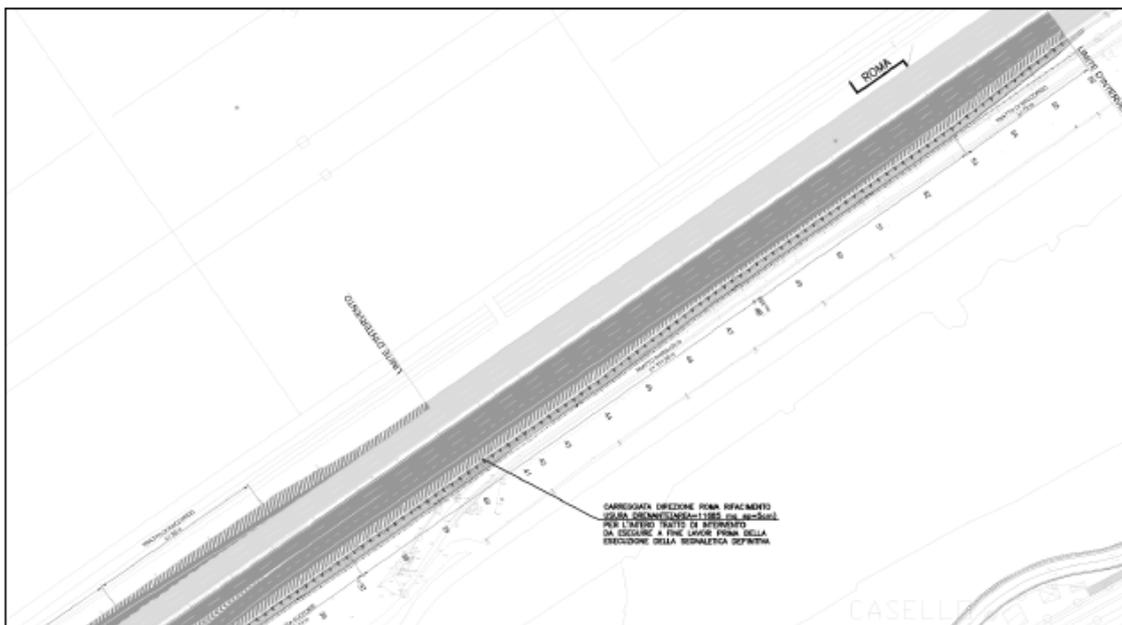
Planimetria di Progetto – Dettaglio immissione su A91 della rampa Cargo City - Roma
